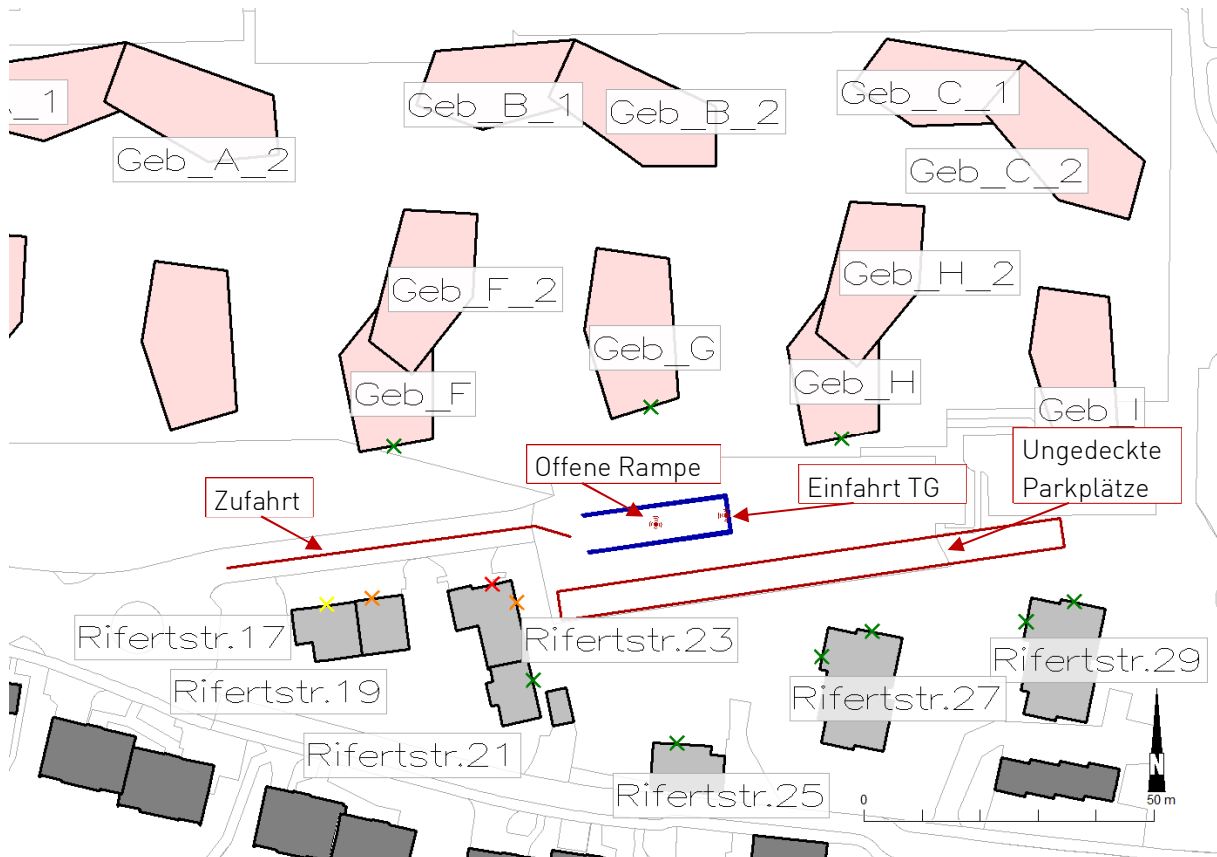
Situationsplan und Lage der Beurteilungspunkte.
